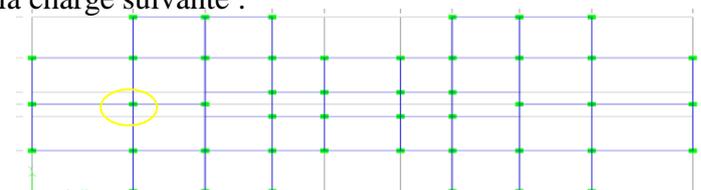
Vue en plan position du poteau la plus sollicité.
